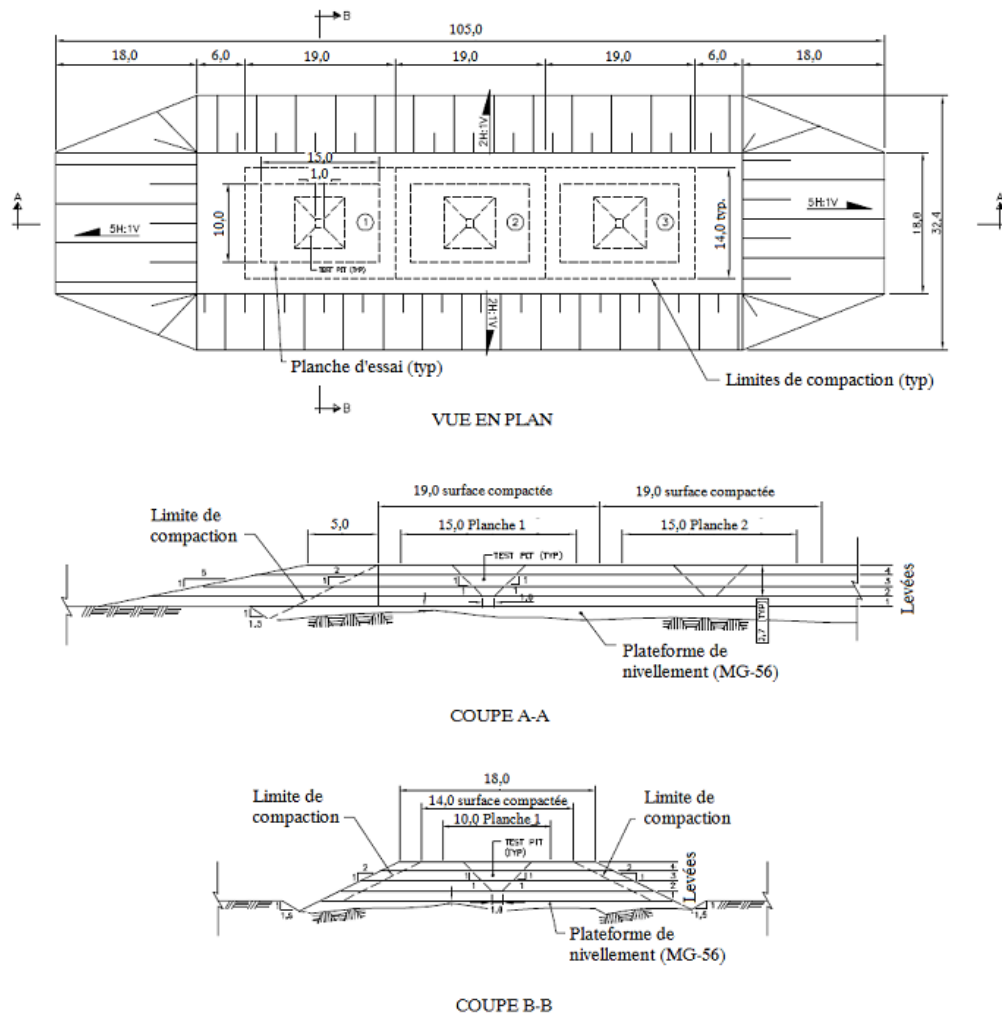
Vue en plan et coupes longitudinale et transversale de planches d'essai types (remblai A). Échelle : 1 : 200. Unité : mètre (modifié de Verret *et al.*, 2013)
